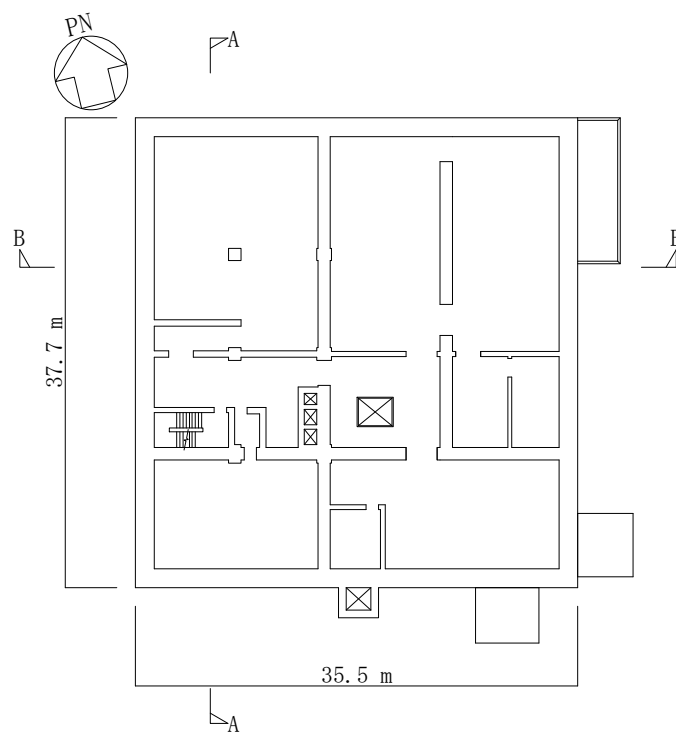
(3/5) 緊急時対策所建屋の概略平面図 (3 階平面図 : EL. 37.0 m)
